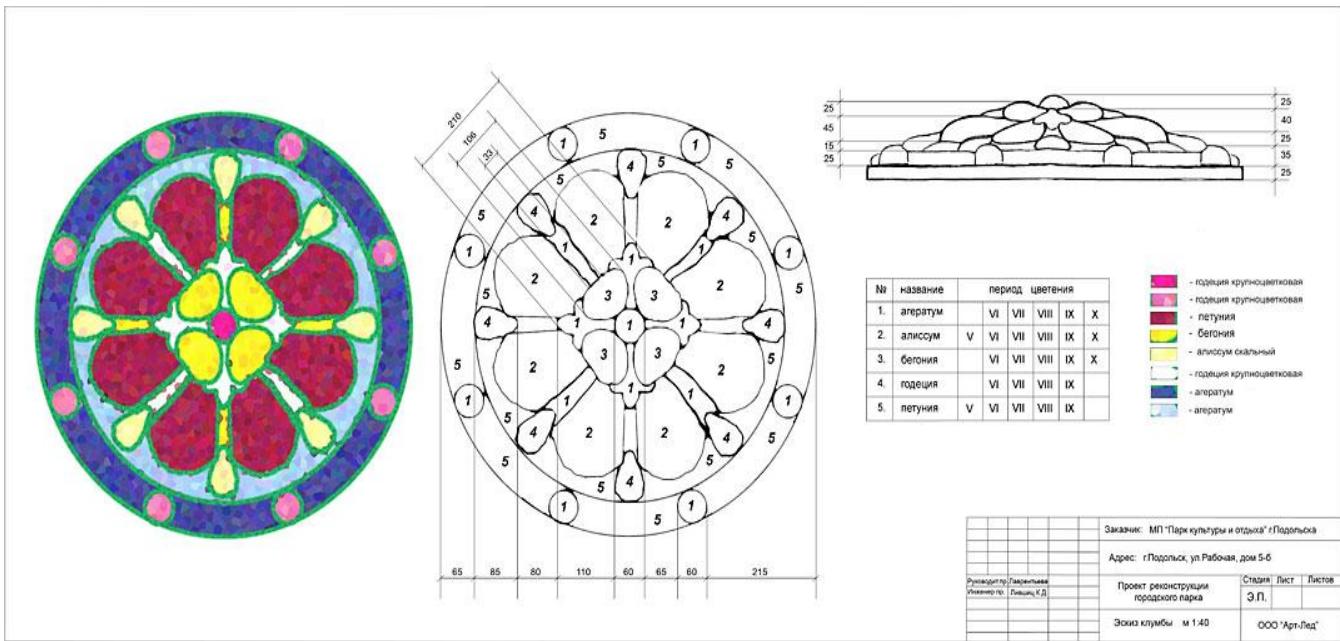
Разбивочно-посадочный чертеж цветника
